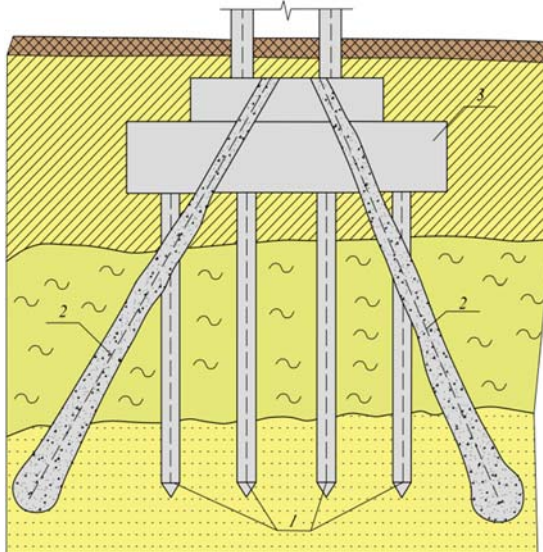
Усиление основания фундаментов при увеличении горизонтальных нагрузок с помощью наклонных буроинъекционных свай: 1 – существующие сваи; 2 – буроинъекционные сваи ЭРТ (РИТ, ФОРСТ, ЭРСТ) усиления; 3 – монолитный железобетонный ростверк
